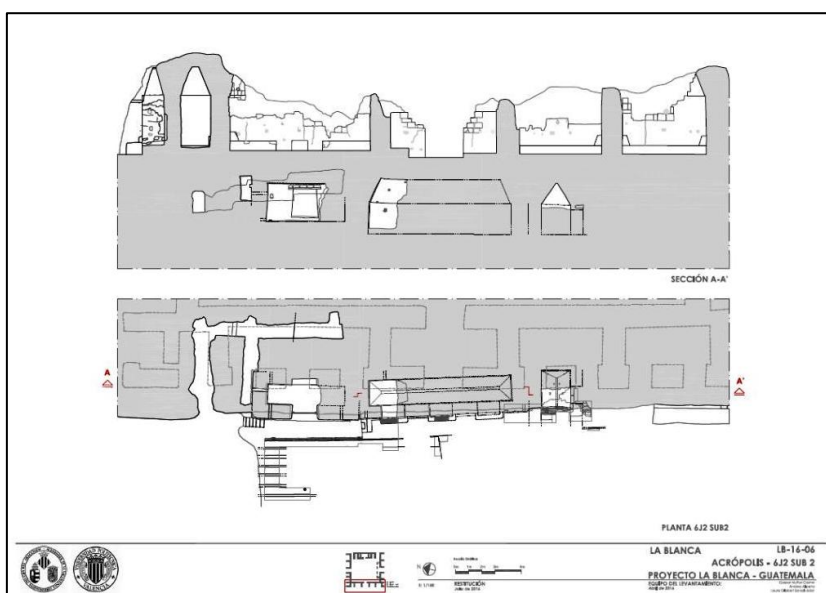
Alzado y planta de los cuartos descubiertos en la subestructura (6J2 Sub2) (Vidal y Muñoz eds., 2016).
